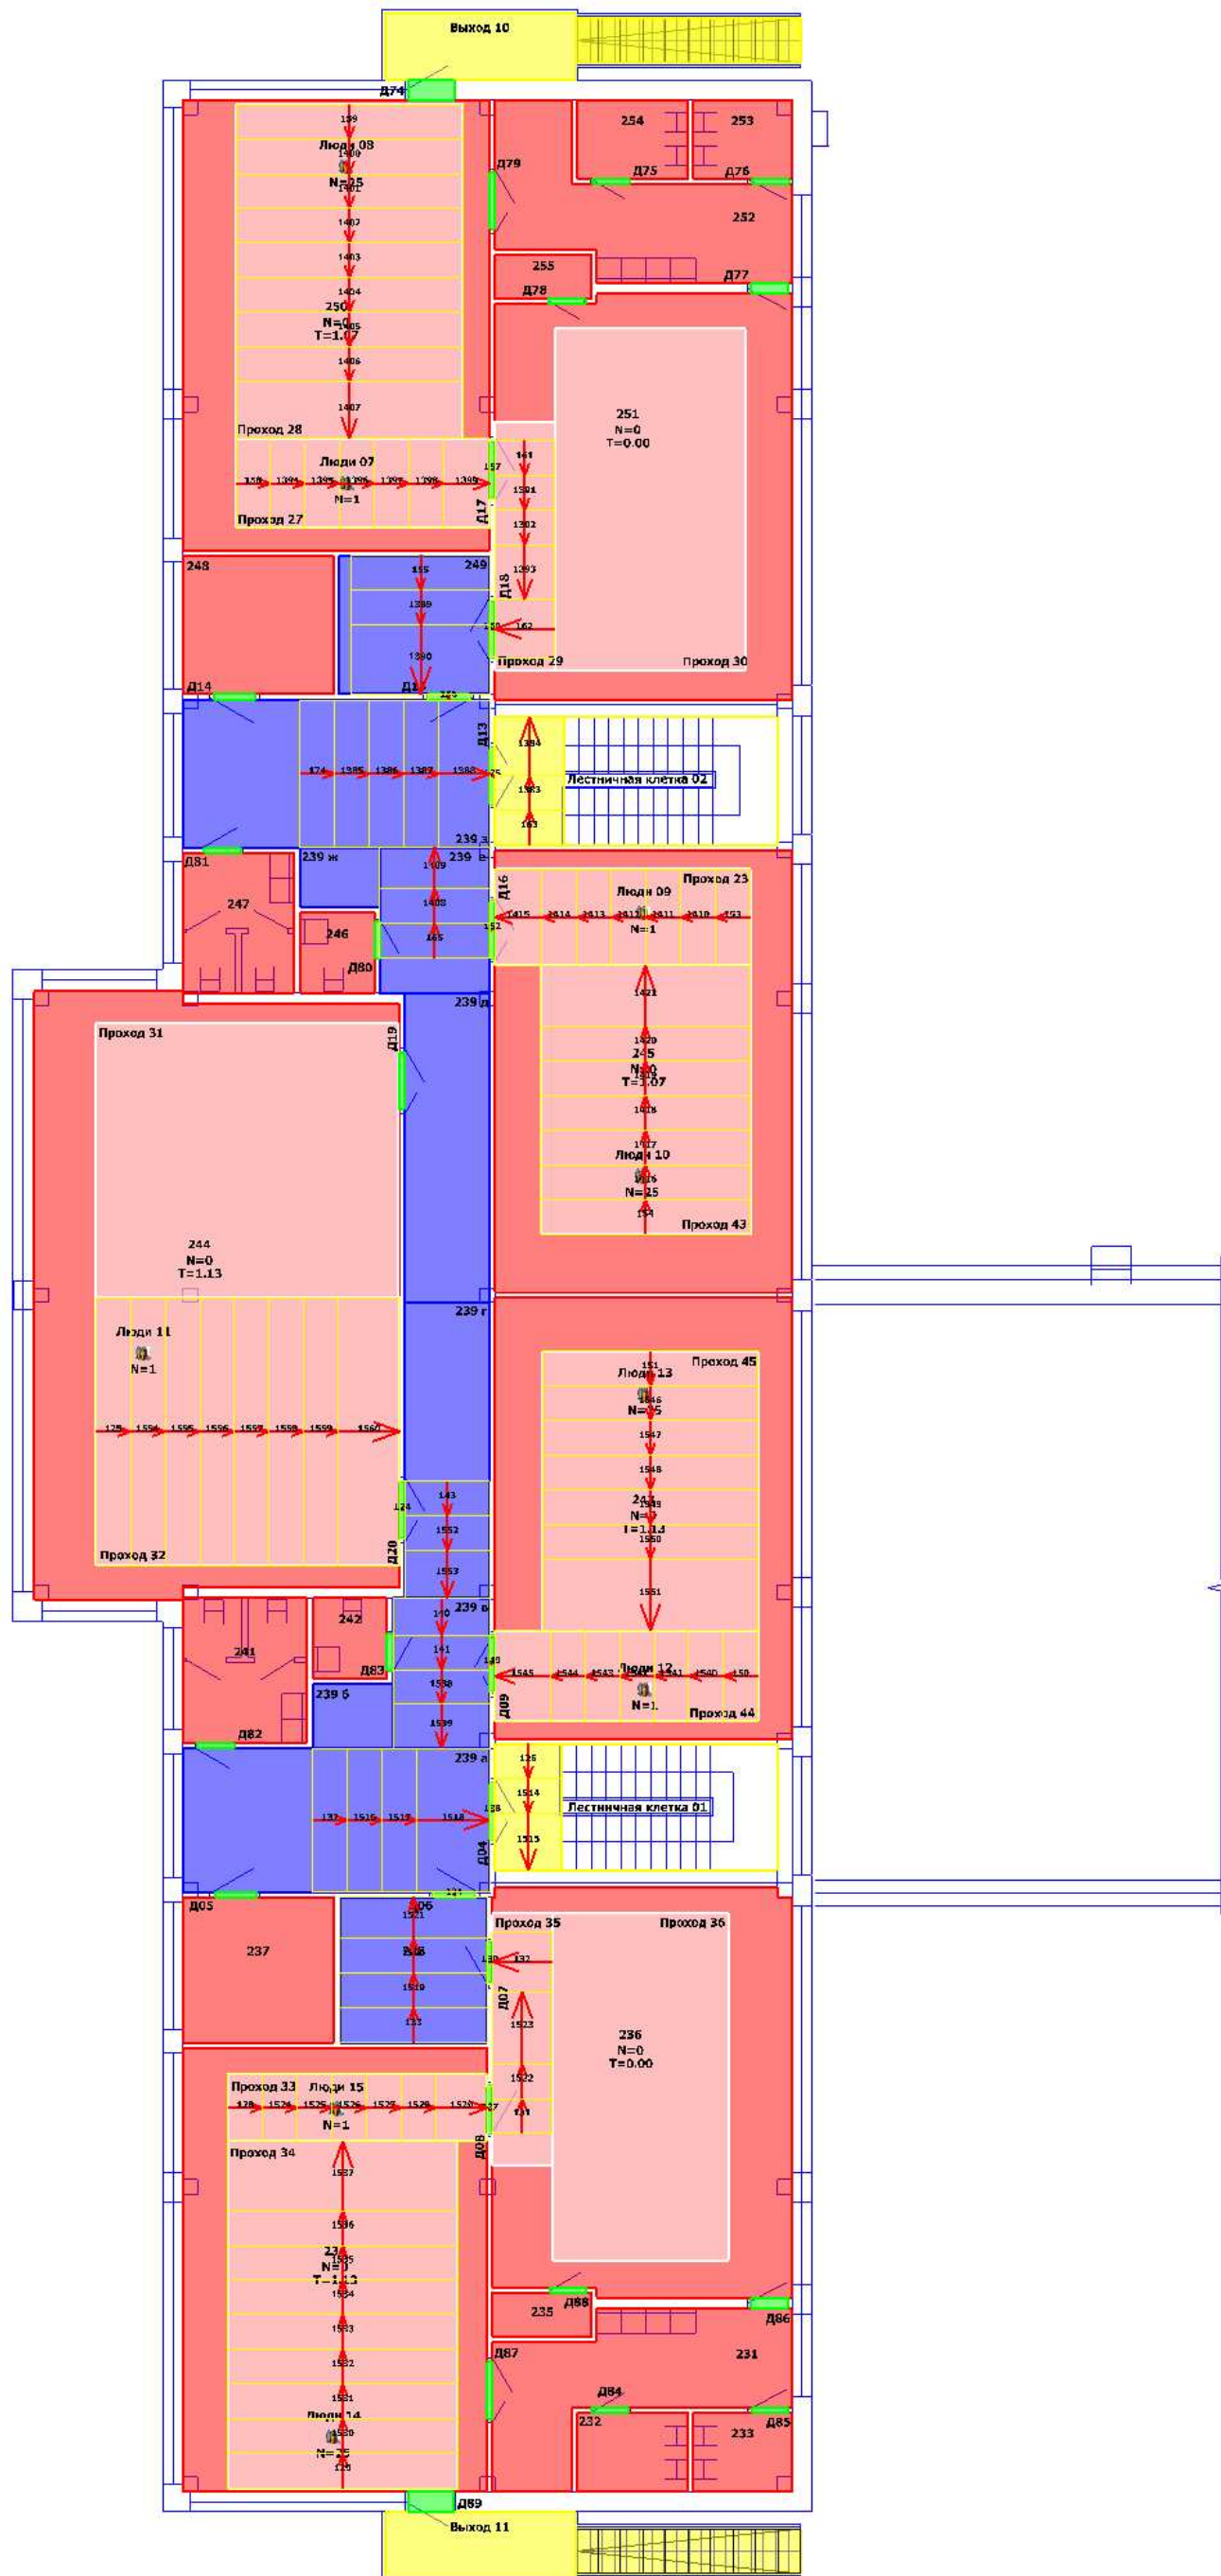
Схема разбиения на участки маршрутов эвакуации из помещений 2-го этажа здания Детского сада на 60 мест с начальной школой на 100 учащихся (Сценарий 01)
